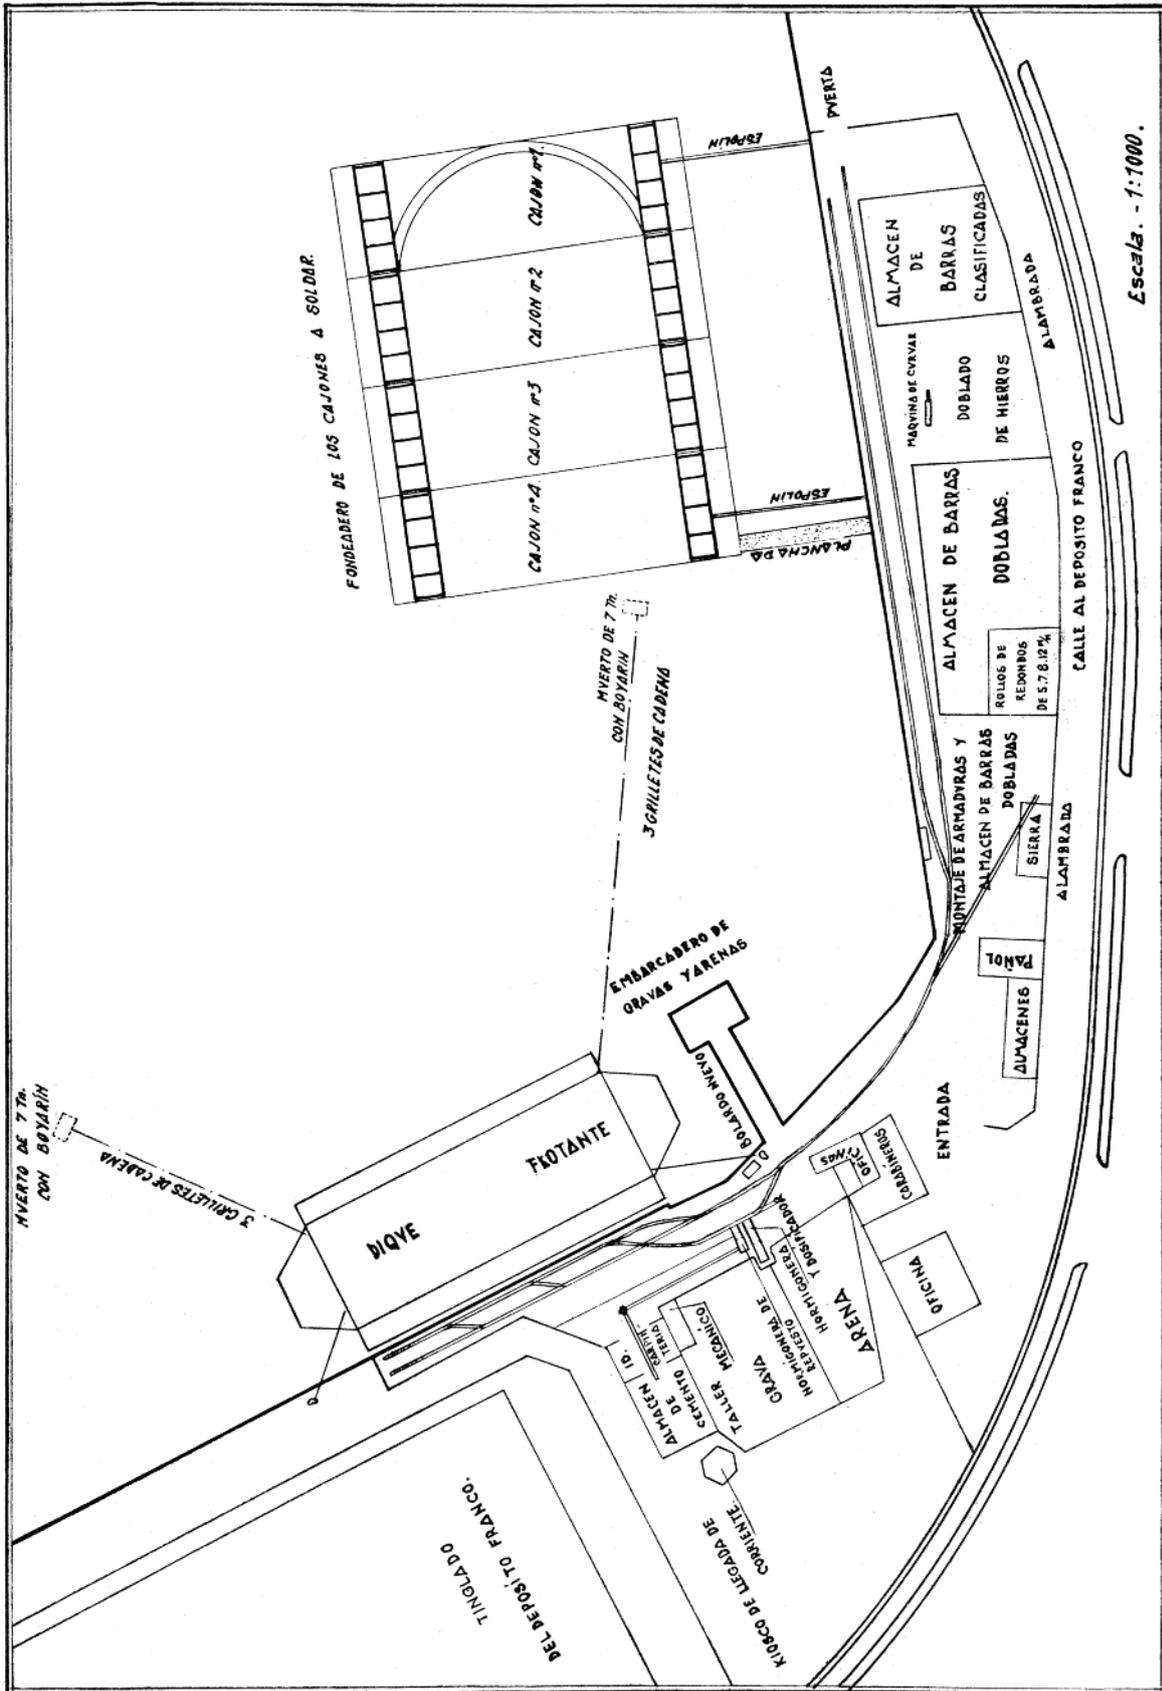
ª Plano general de las instalaciones en tierra para la construcción de los cajones de hormigón armado
